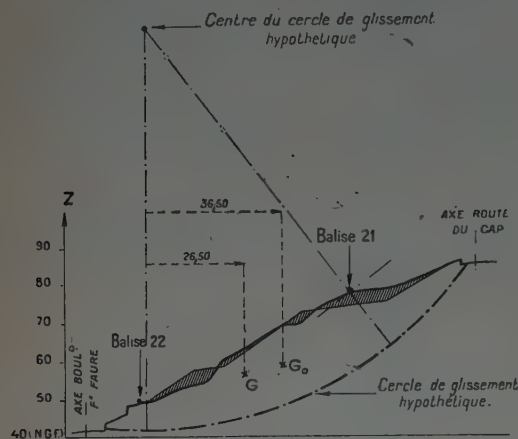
Coupe en travers de la falaise passant par la balise n° 21.
